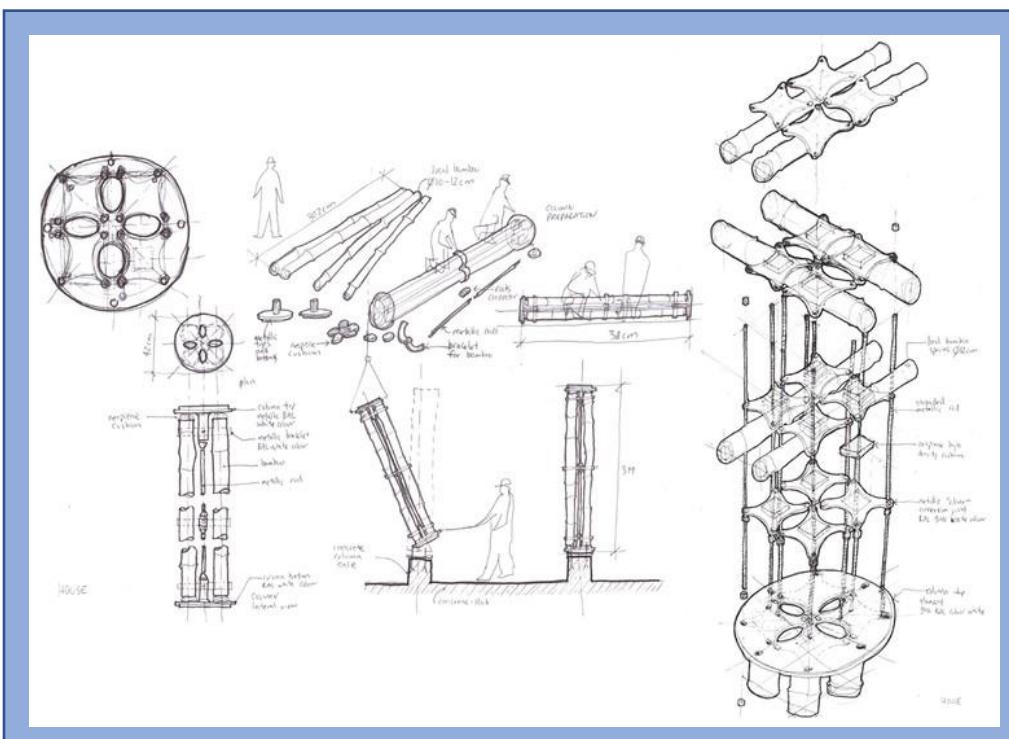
Fuente Plataforma Arquitectura, Detalle de ensamblajes.
